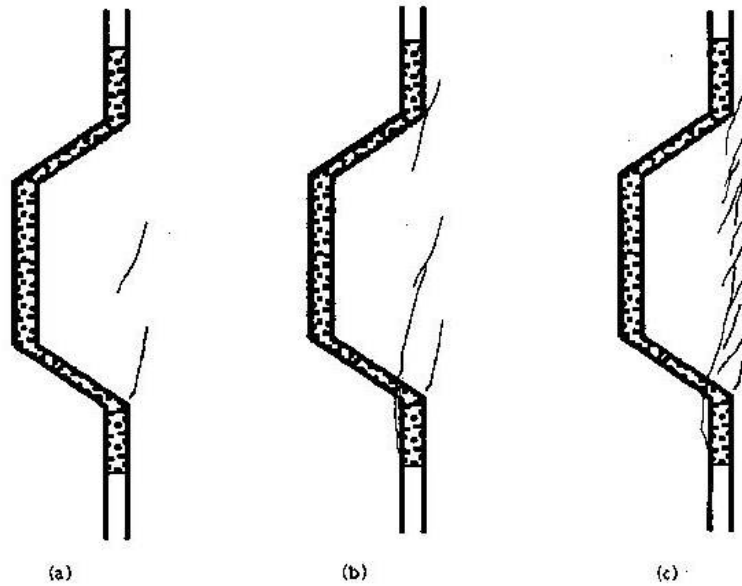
Secuencia de fisuras en junta con resina epoxy con una llave
